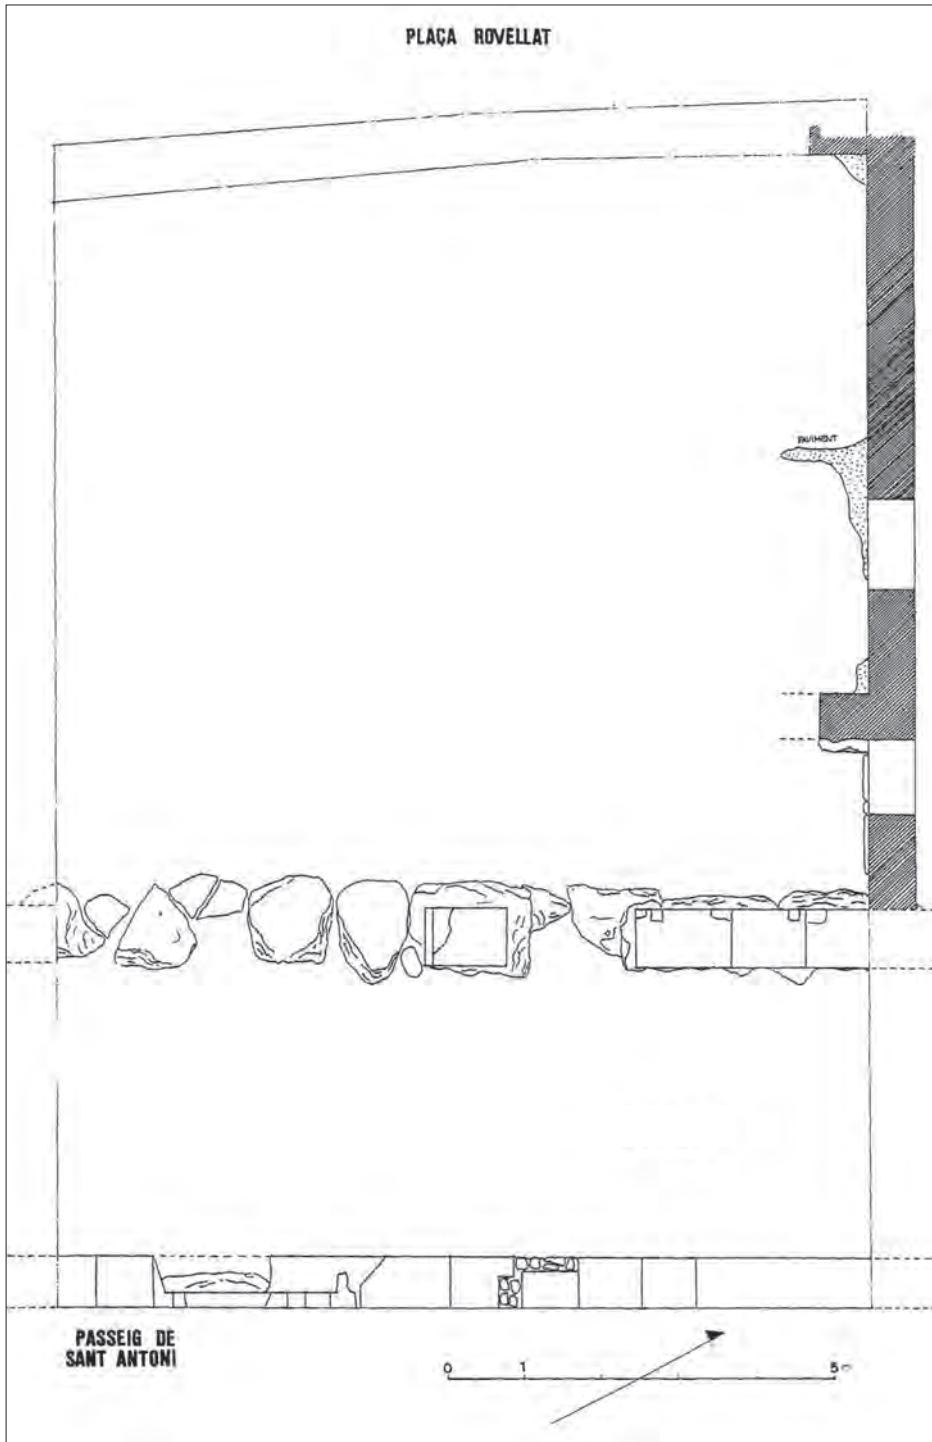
Planta de la intervenció en el núm. 1-2 de la plaza Rovellat (Ll. Piñol).
